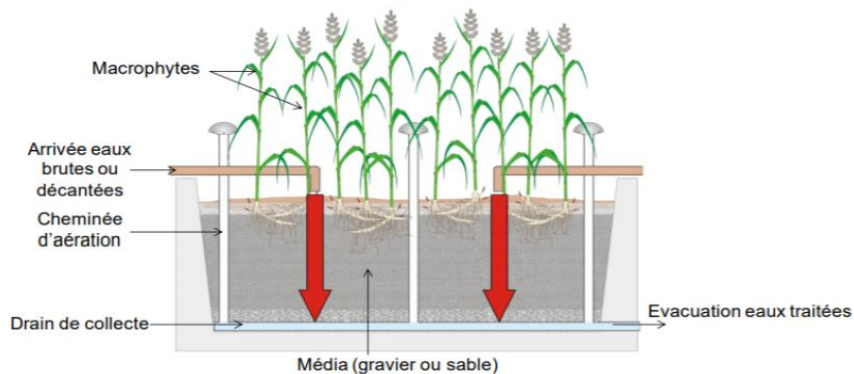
Coupe transversale d'un filtre à écoulement vertical (Molle, 2003)
